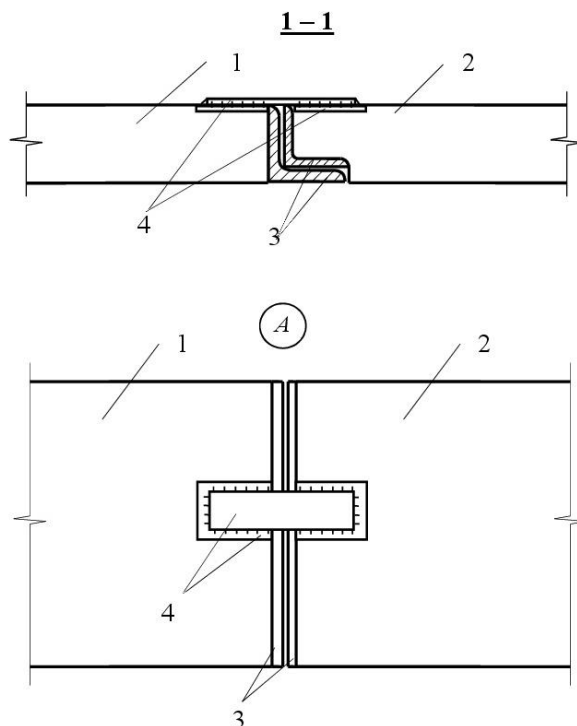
Вузол з'єднання плит у збірному безбалковому перекритті:
